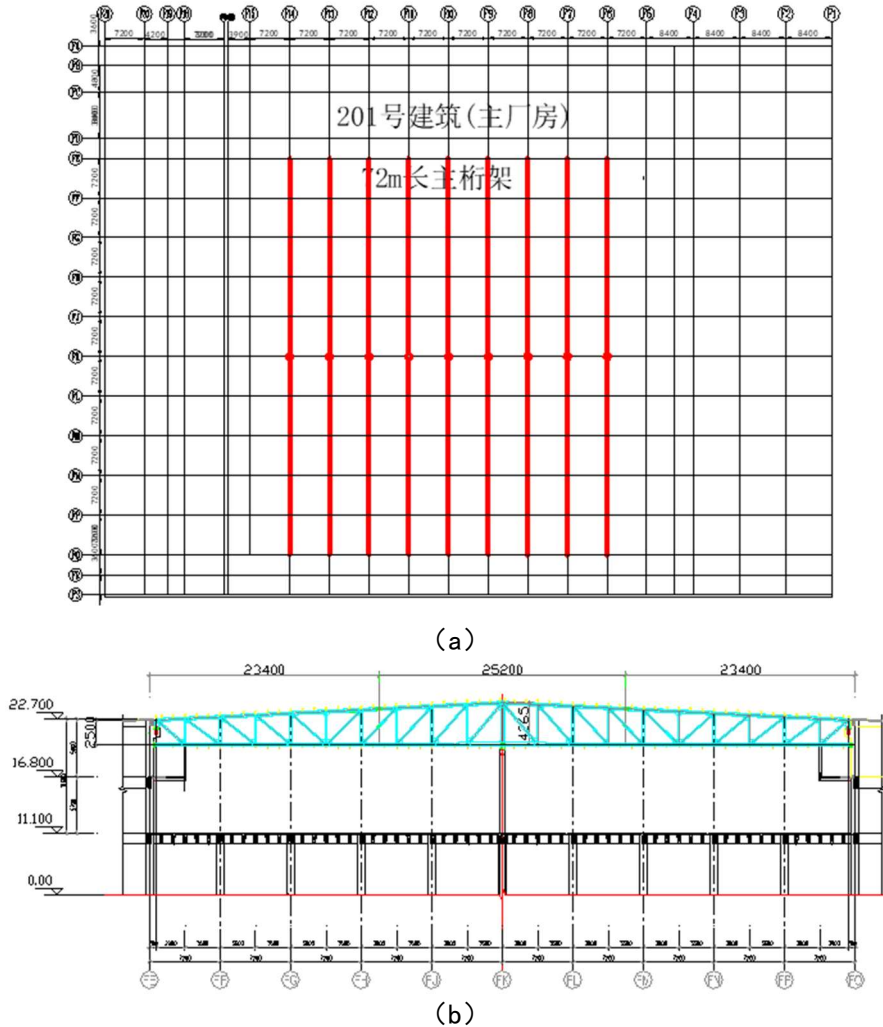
主厂房平、剖面图 (a) 平面图 (b) 剖面图
